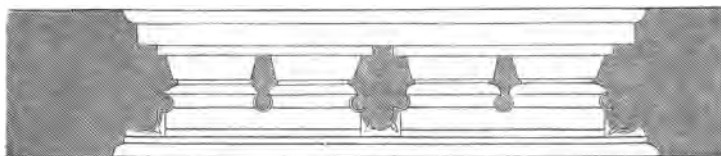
Grundriss eines Fensters zu Obermarsberg.
